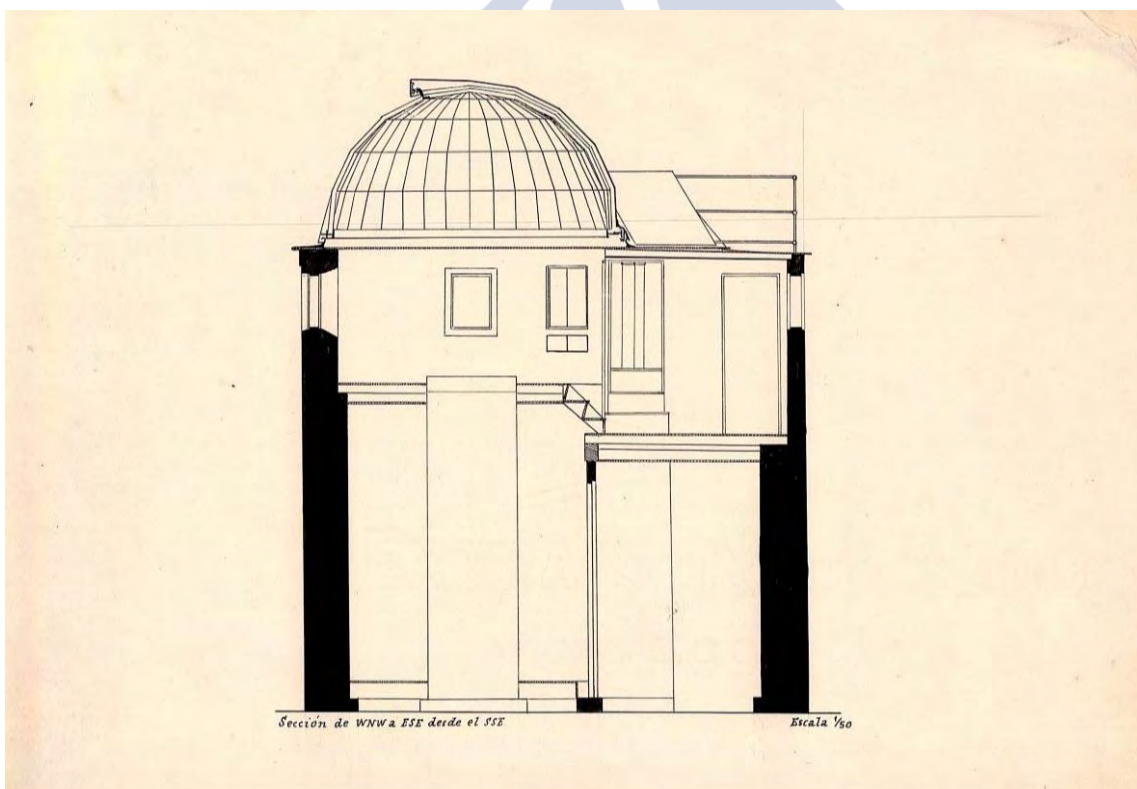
Sección de la fachada Suroeste del Observatorio de Lalín, a escala 1/50
